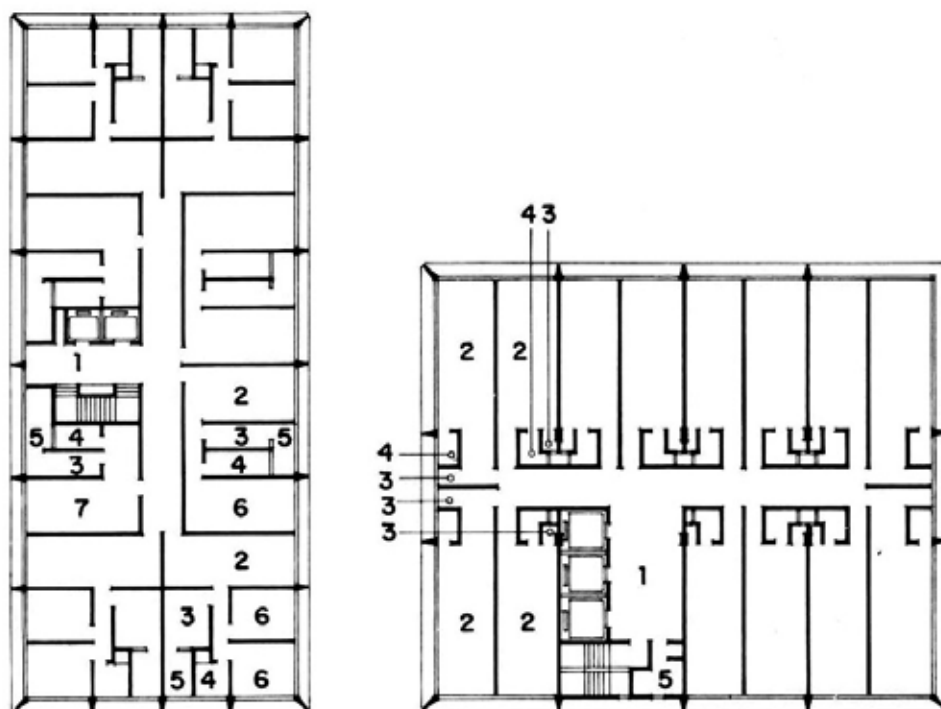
planta pavimento tipo (EDIFÍCIO APARTAMENTOS): 1) hall elevadores; 2) estar; 3) cozinha; 4) banheiro; 5) serviço; 6) dormitório; 7) sala/dormitório. (EDIFÍCIO ESCRITÓRIOS): 1) hall elevadores; 2) escritório; 3) cozinha; 4) sanitário; 4) serviço.
